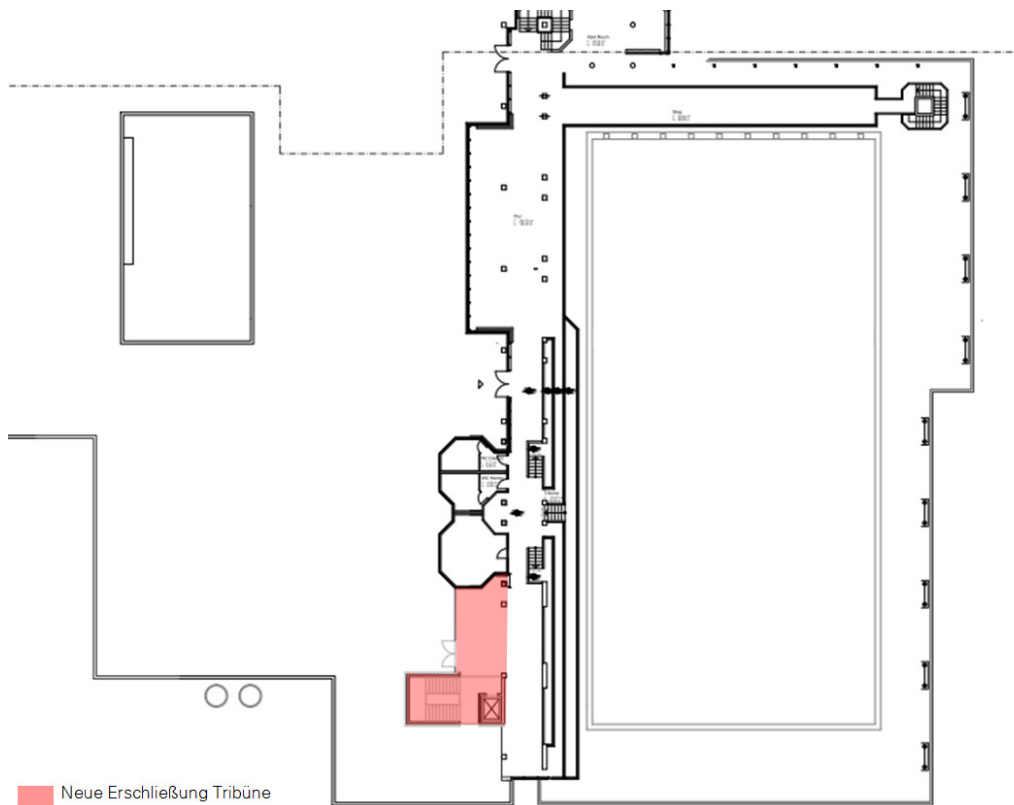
Grundriss Ebene 2, Tribüne mit direkter Verbindung zum Foyer (Treppenhaus)
